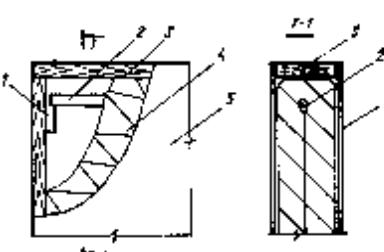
Схема крепления прошивных минераловатных матов в конструкции стены на «перекладине»
